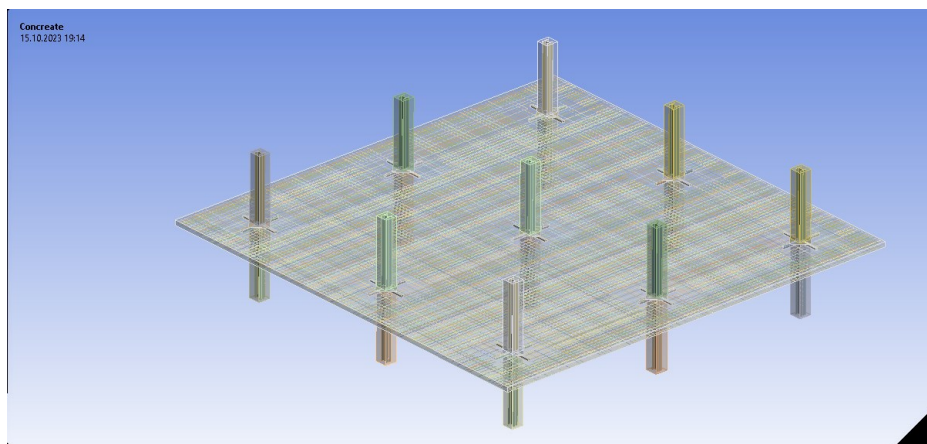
Расчетная схема перекрытия с балочными срезными узлами в расчетной среде Ansys
